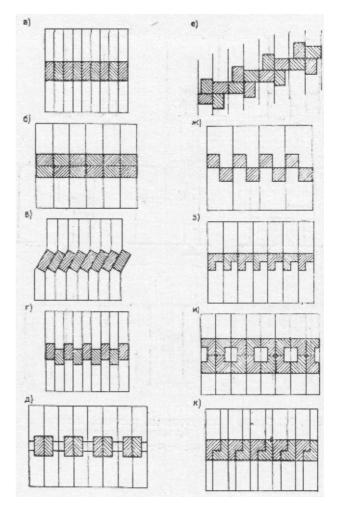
Схемы блокировки квартир-блоков а — однорядная; δ — двухрядная; ϵ — пилообразная; ϵ — со сдвигами в обе стороны; δ — с включением хозяйственных пристроек; ϵ — крестообразная; κ — шахматная; κ — блокировка Г-образных квартир-блоков, при которой образуются дворики; κ — компактная блокировка Г-образных квартир
